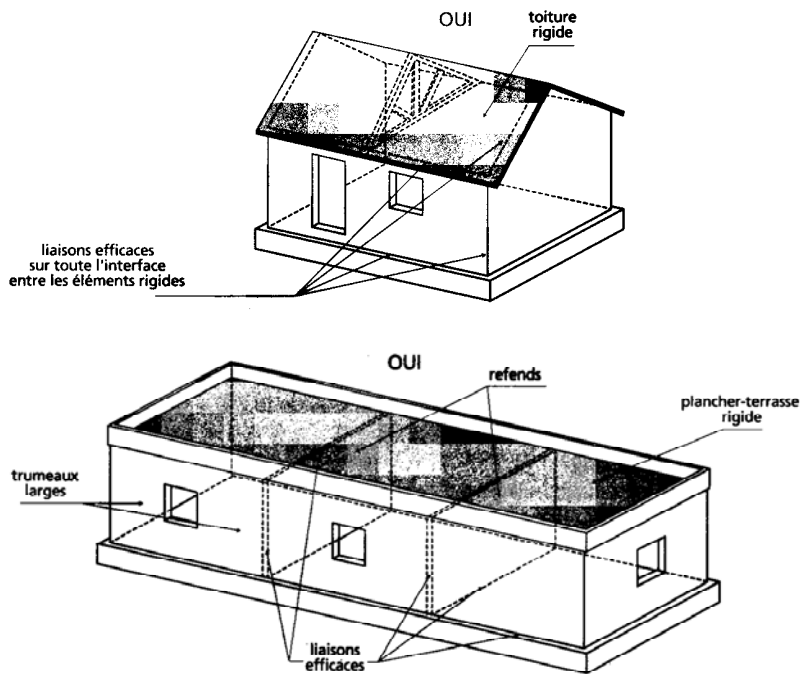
Constructions dont la conception est correcte ("boîte" rigide) (Zacek, 1996)
